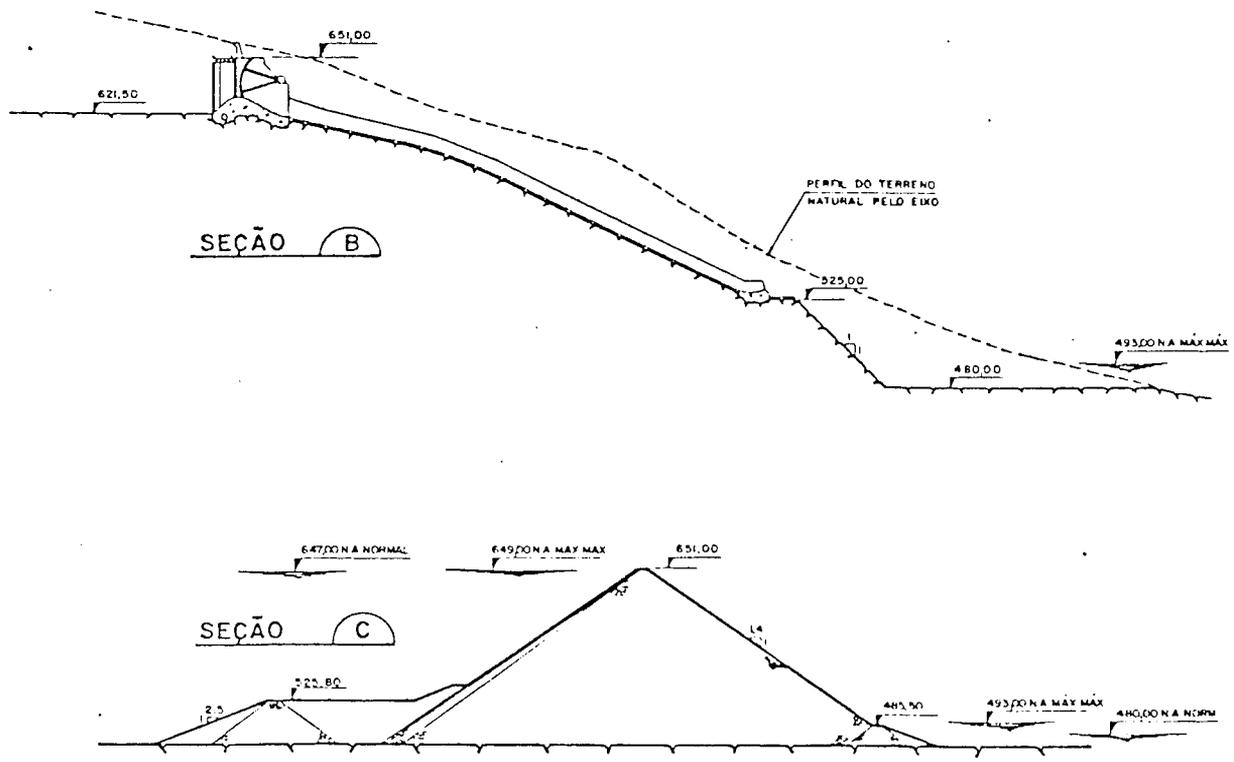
ALTERNATIVA COM BARRAGEM DE ENROCAMENTO COM FACE DE CONCRETO - ARRANJO GERAL
